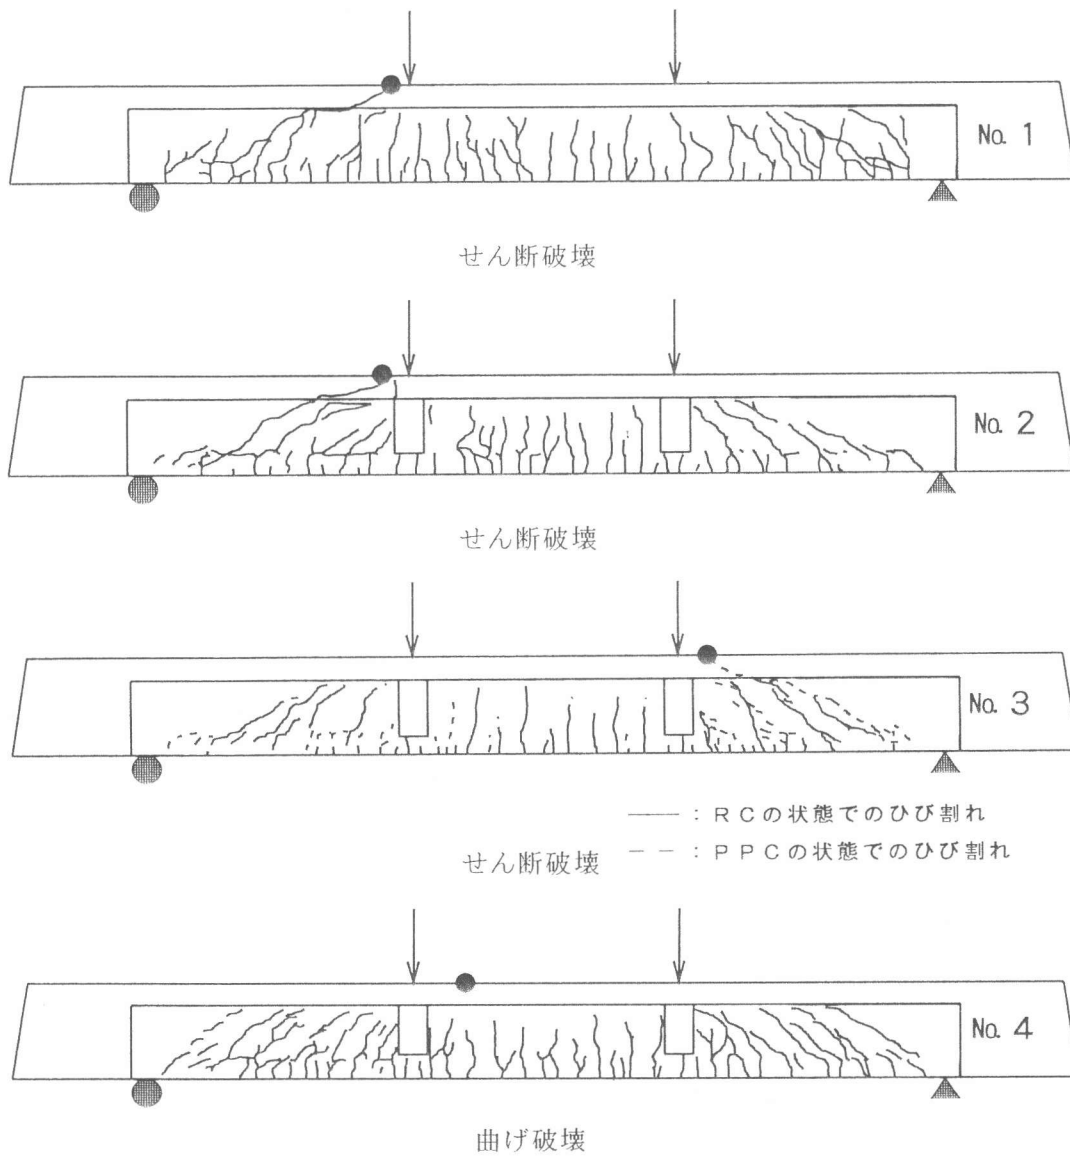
破壊時のひび割れ状況および破壊箇所
